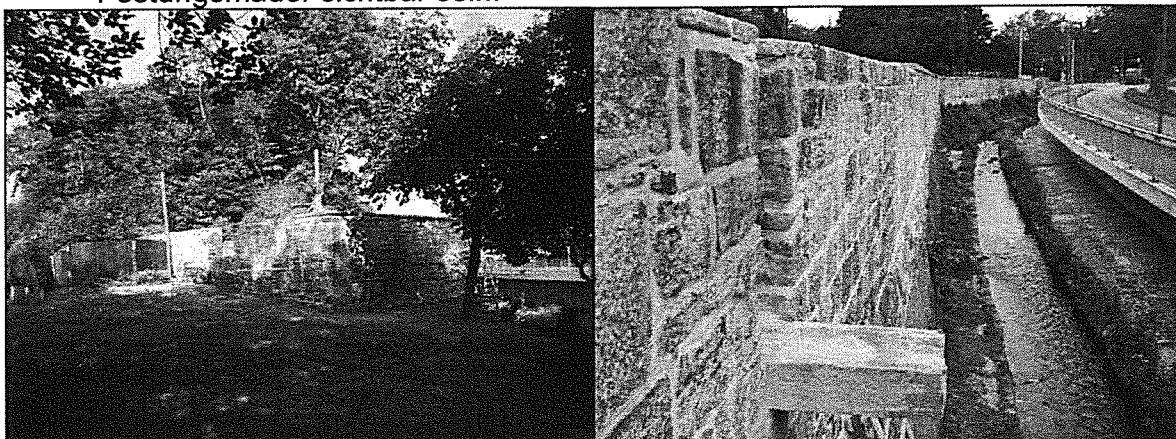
, 15: Stadtbefestigung mit Rampenöffnung ¹
